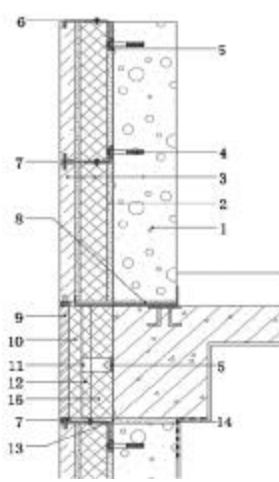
保温装饰复合蒸压加气混凝土一体外
